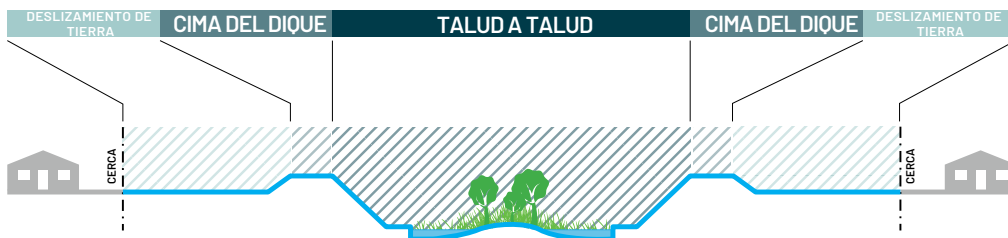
Hay algunas tipologías de canales trapezoidales a lo largo del Río de Los Ángeles. El canal trapezoidal tiene un fondo blando o de hormigón y puede o no tener diques visibles.
